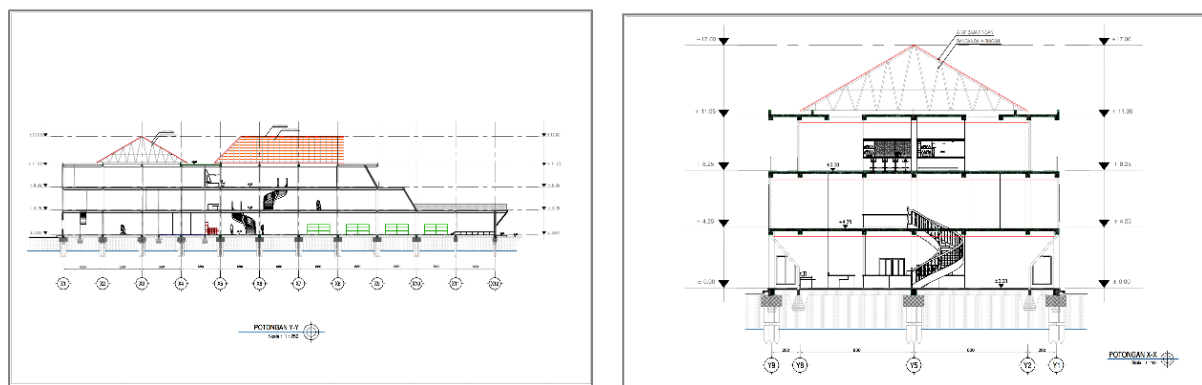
Denah Bangunan Perpustakaan Terapung Danau Mawang
